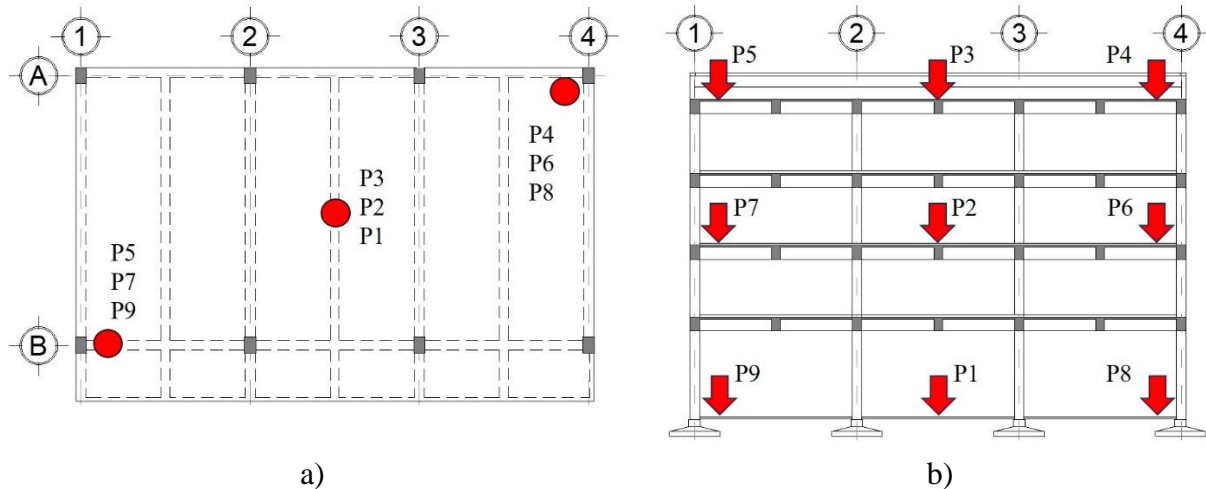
Pontos de medição de VA; a) localização dos pontos de medição na planta tipo; b) localização dos pontos no corte geral.
